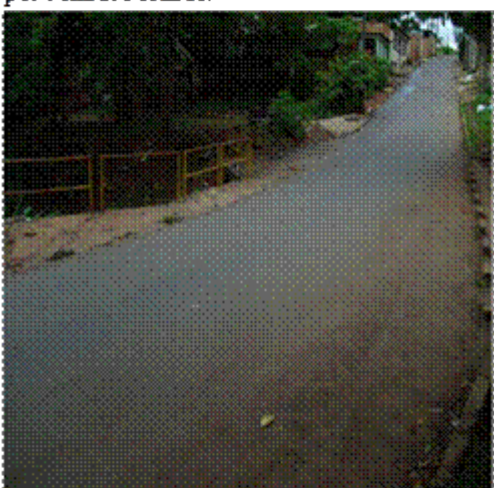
Ponto 3, canalização e divisão do parque por via pavimentada.
